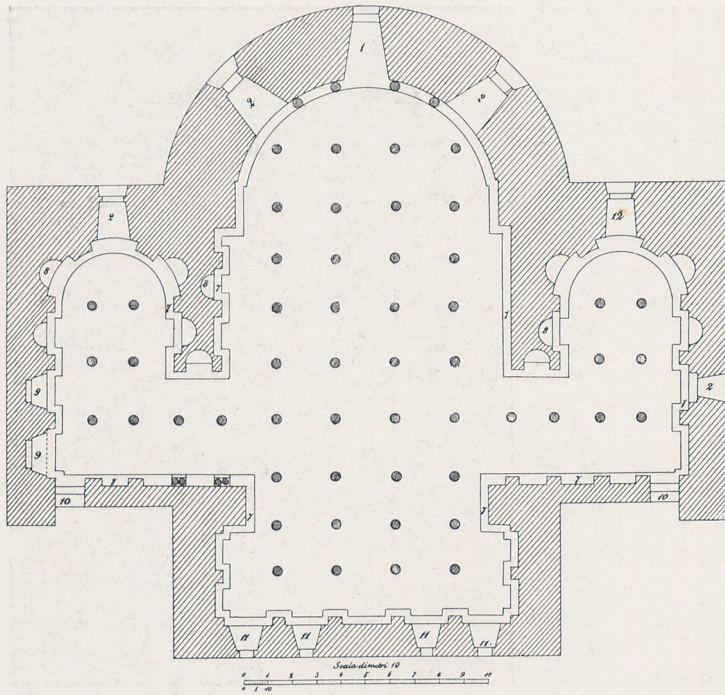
Venedig, S. Marco. Grundriß der Krypta (nach Berchet)
